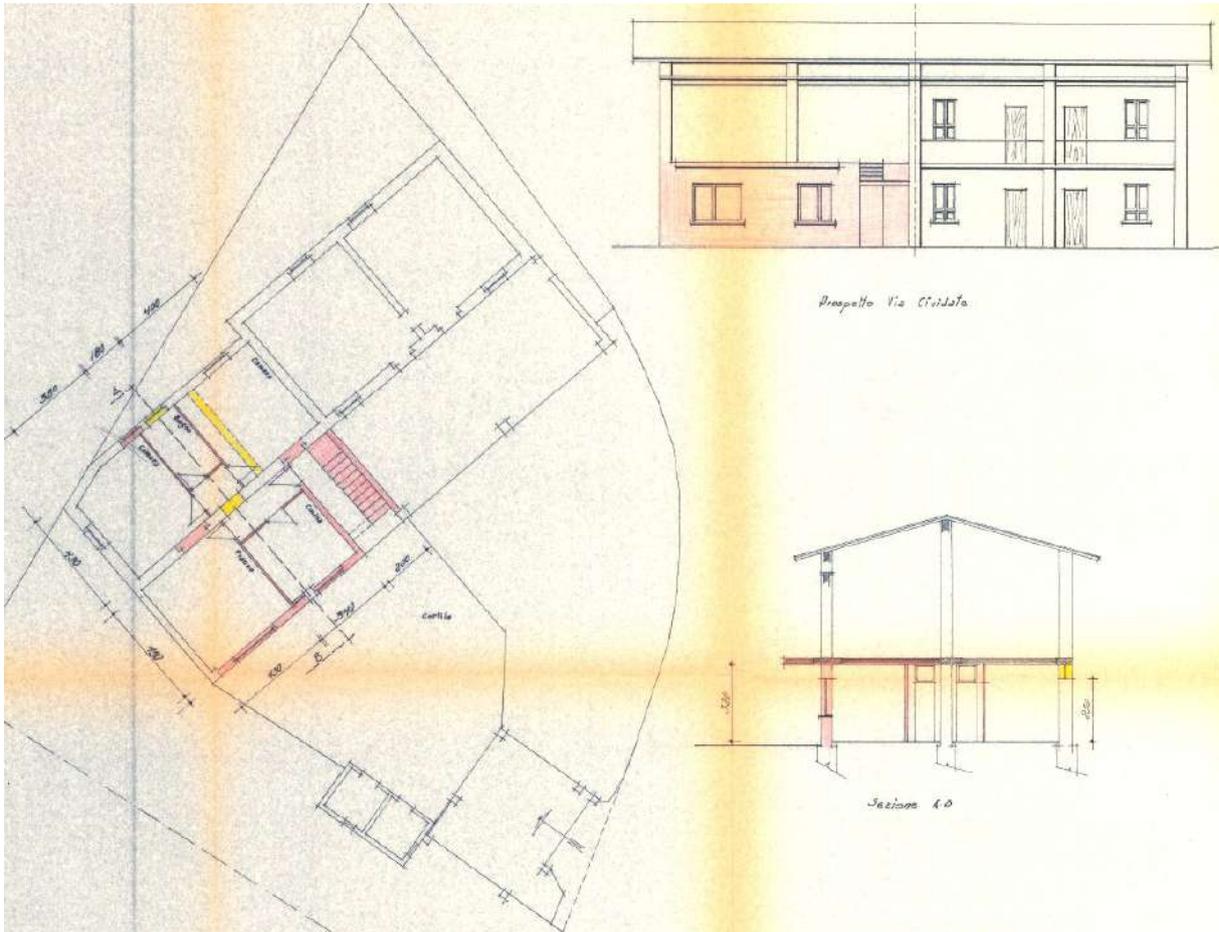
Licenza di Costruzione n°1205 prot. n°3516 del 08/11/1972 stralcio tavola di progetto del piano terra dove viene realizzata anche la scala di accesso al piano primo
